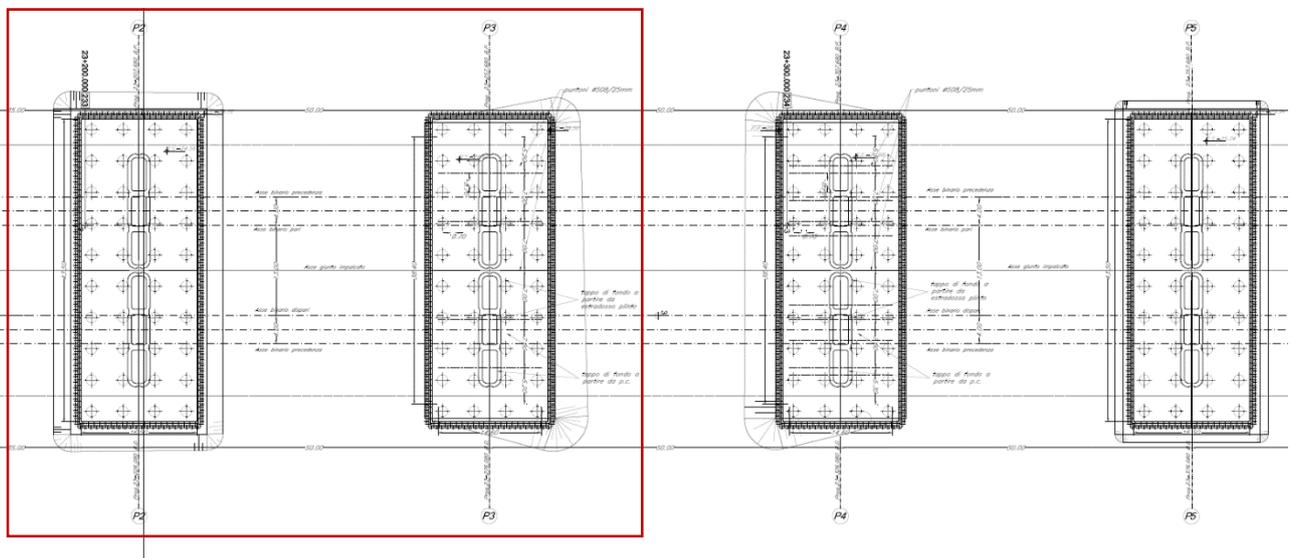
Viadotto VI03 – PD – Pianta scavi fondazioni
